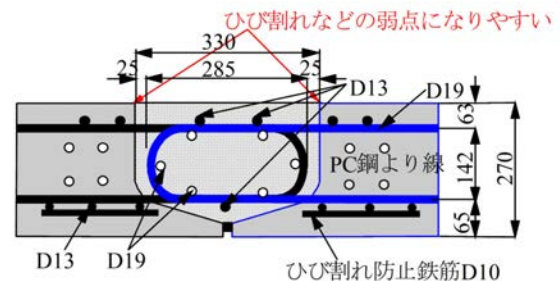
打ち継ぎ部のひび割れ (想定) <sup>5)</sup>
